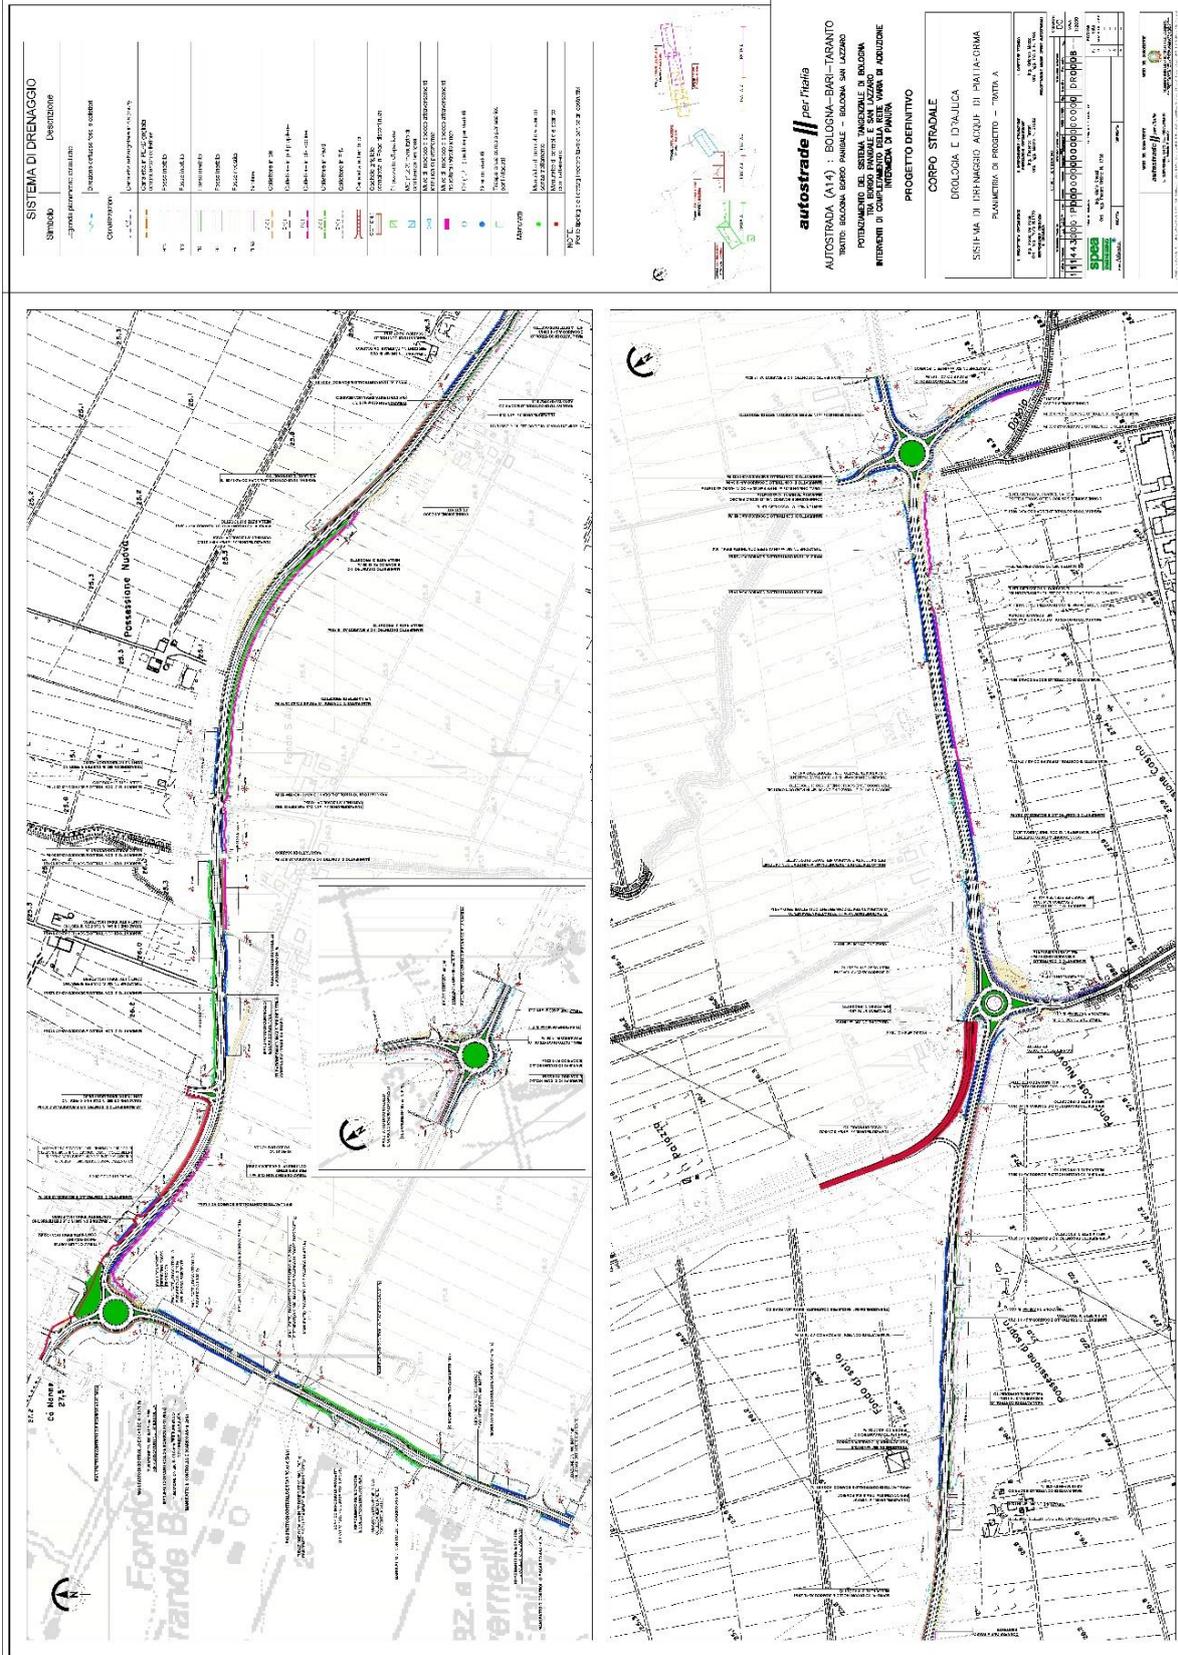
Intermedia di Pianura, progetto definitivo, planimetria tratta A
